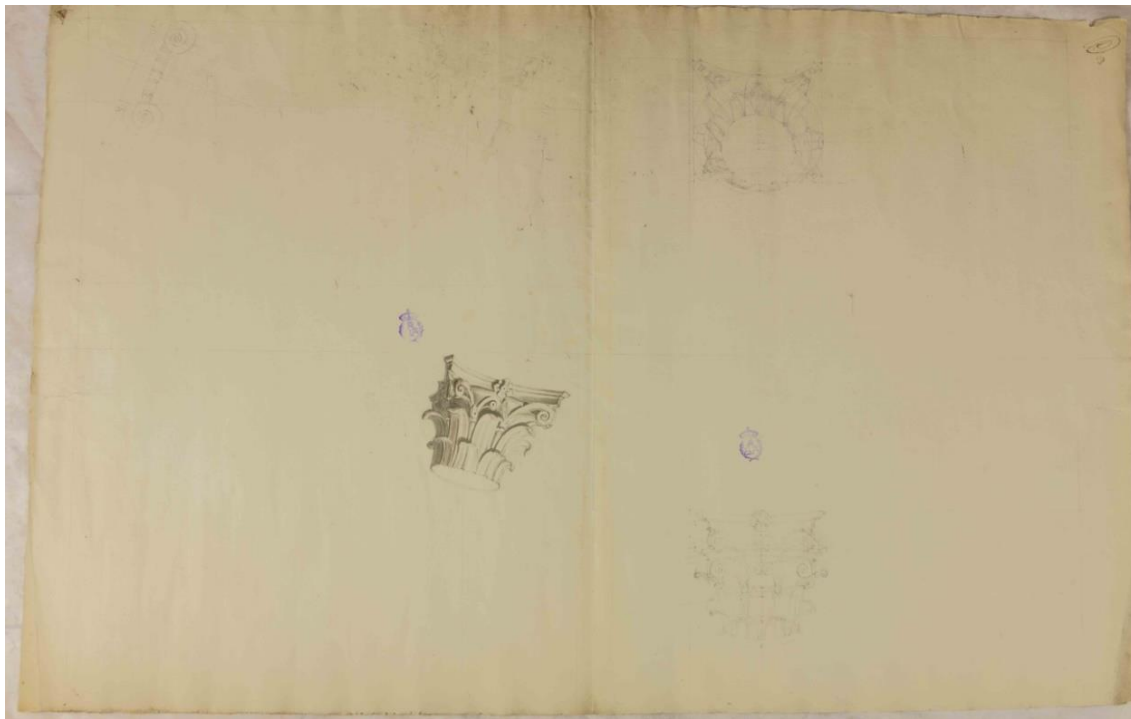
Dibujo A-5606: Planta y alzado de un capitel corintio y alzado de un capitel jónico, Archivo R.A.B.A.S.F.
